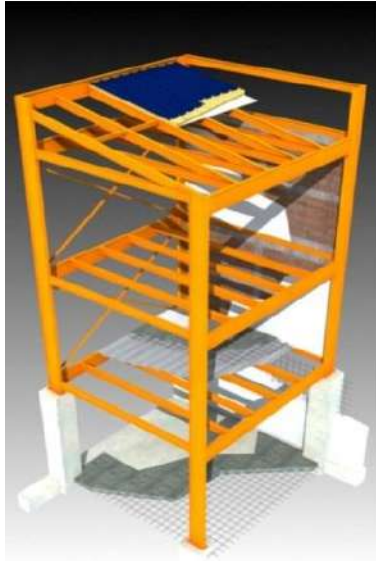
sistema constructivo pórticos metálicos alma llena contemporáneo.
